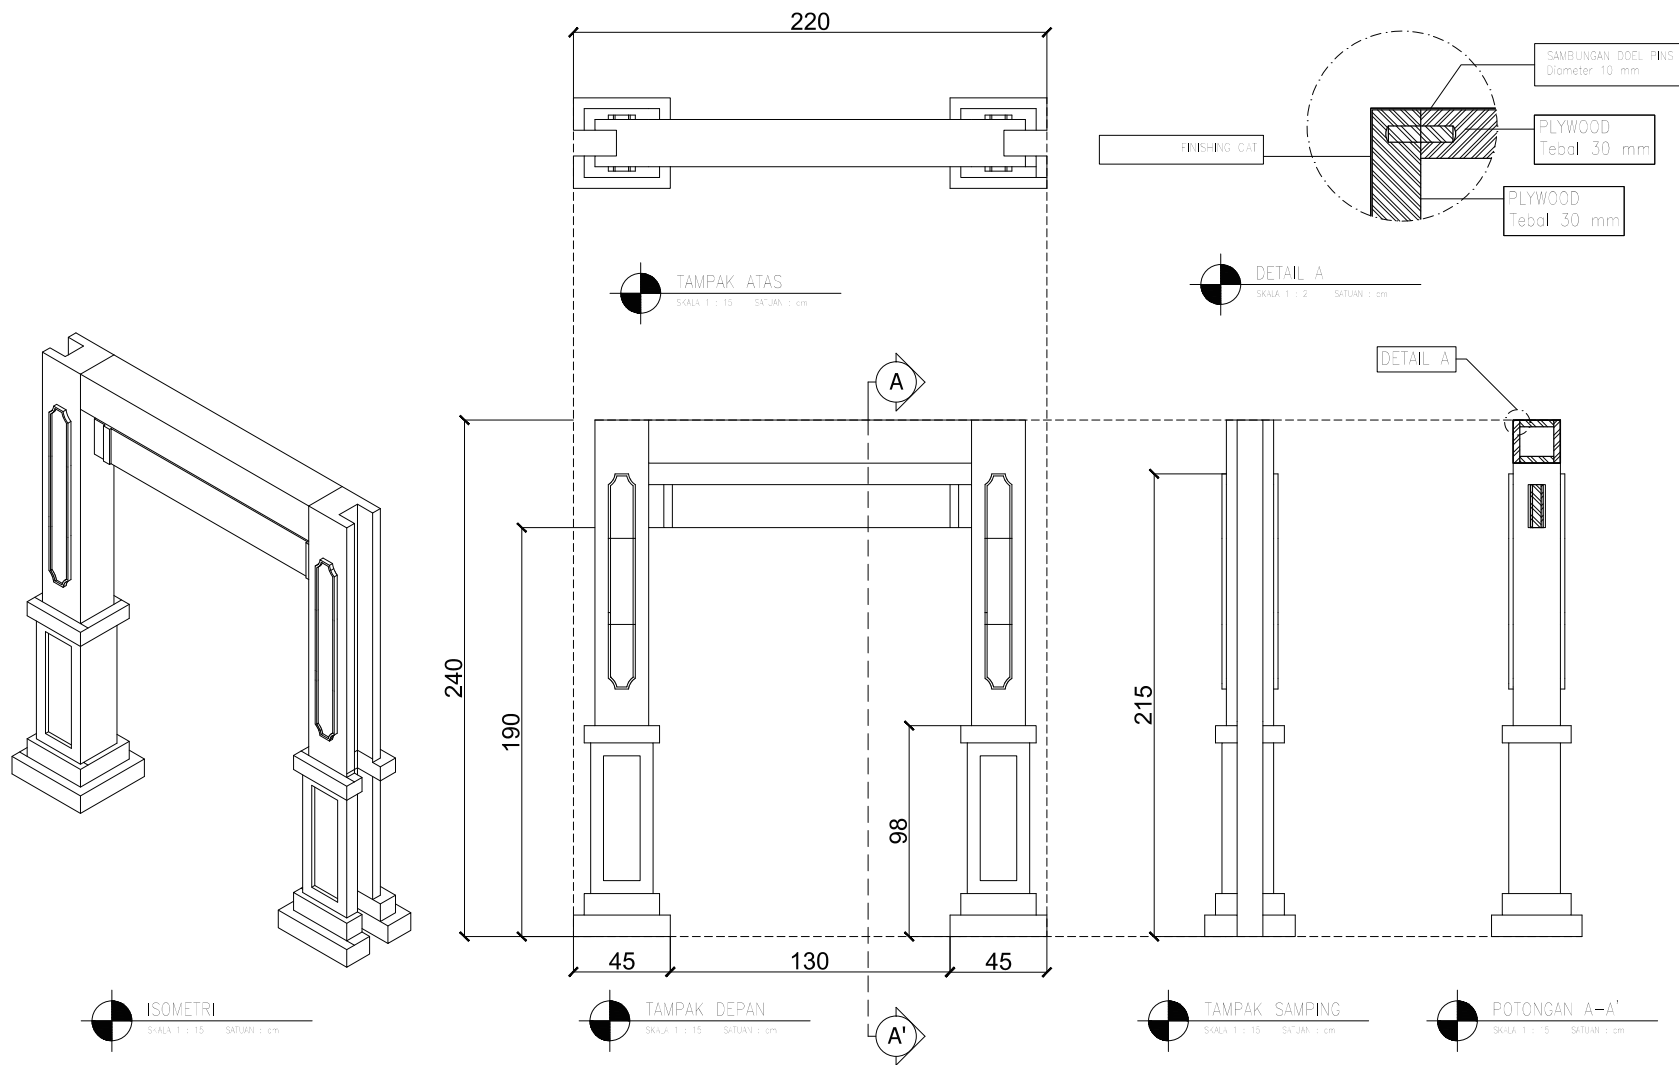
DETAIL ELEMEN ESTETIS RUANG TERPILIH 2
